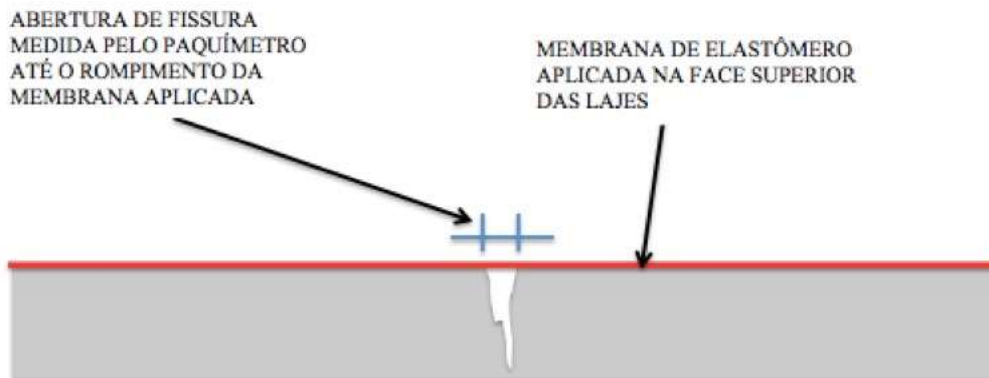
Croqui ilustrativo da maneira de medição das aberturas das fissuras na lateral das lajes com os sistemas impermeabilizantes aplicados
